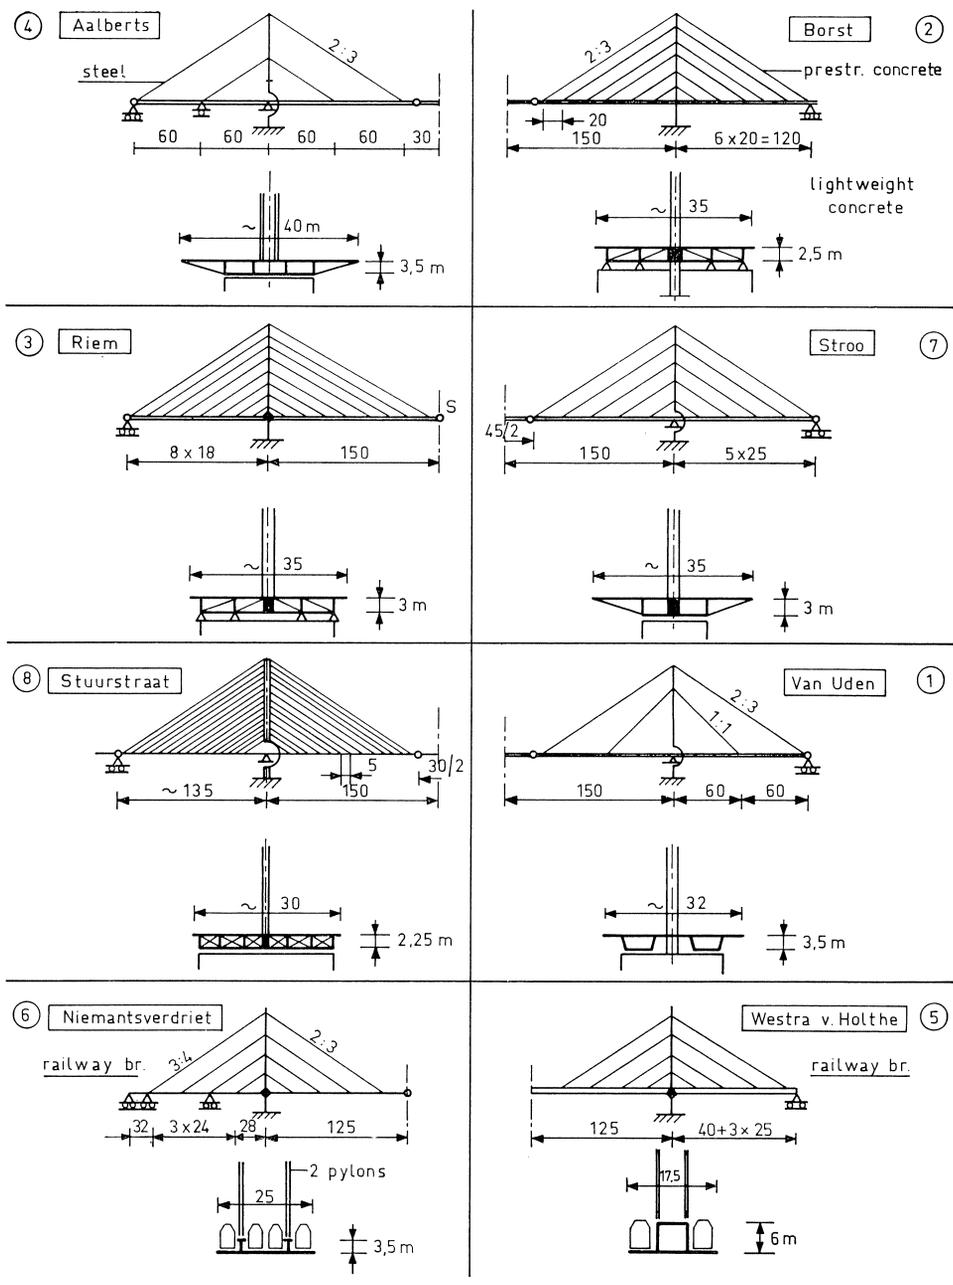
Einige untersuchte Schrägseilbrücken.
